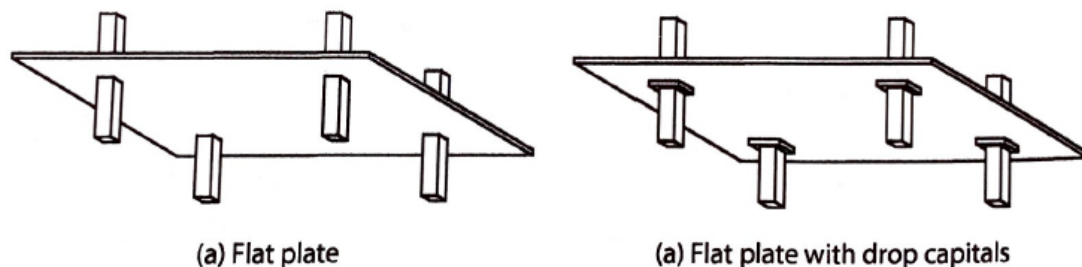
Losa plana (a) y losa con capiteles (b). (Moehle, 2015)
